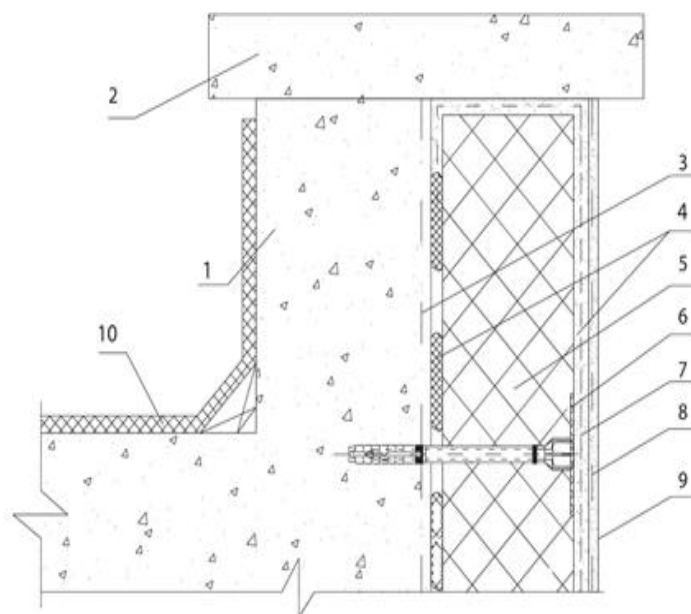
Улаштування теплоізоляції на останньому поверсі в будівлі з плоским дахом
